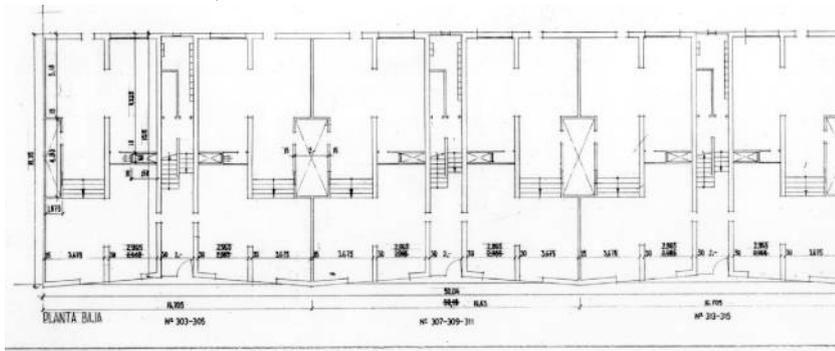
Planta baja de las viviendas. Los bloques están separados por un corte que contiene la escalera y lavaderos. Arxiu MBM.
